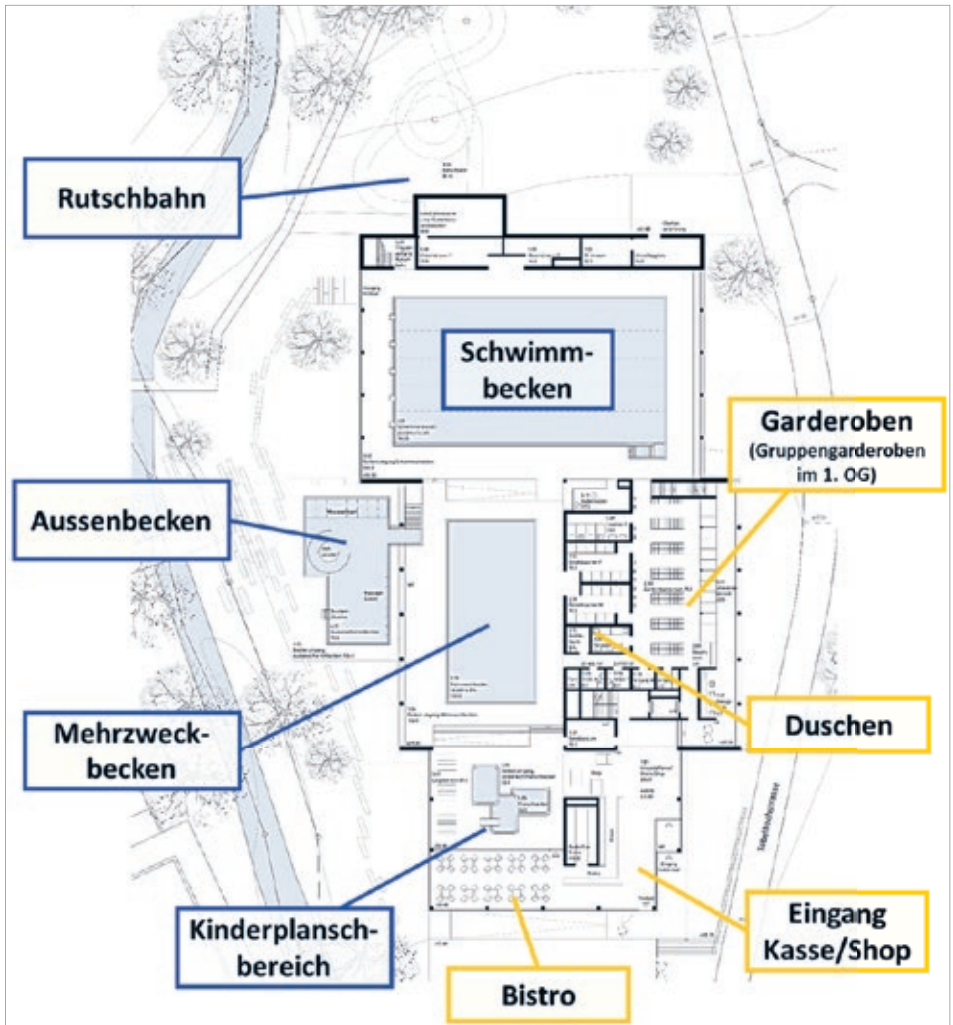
Grundriss mit Kernelementen des Hallenbads (ohne Wellness)
